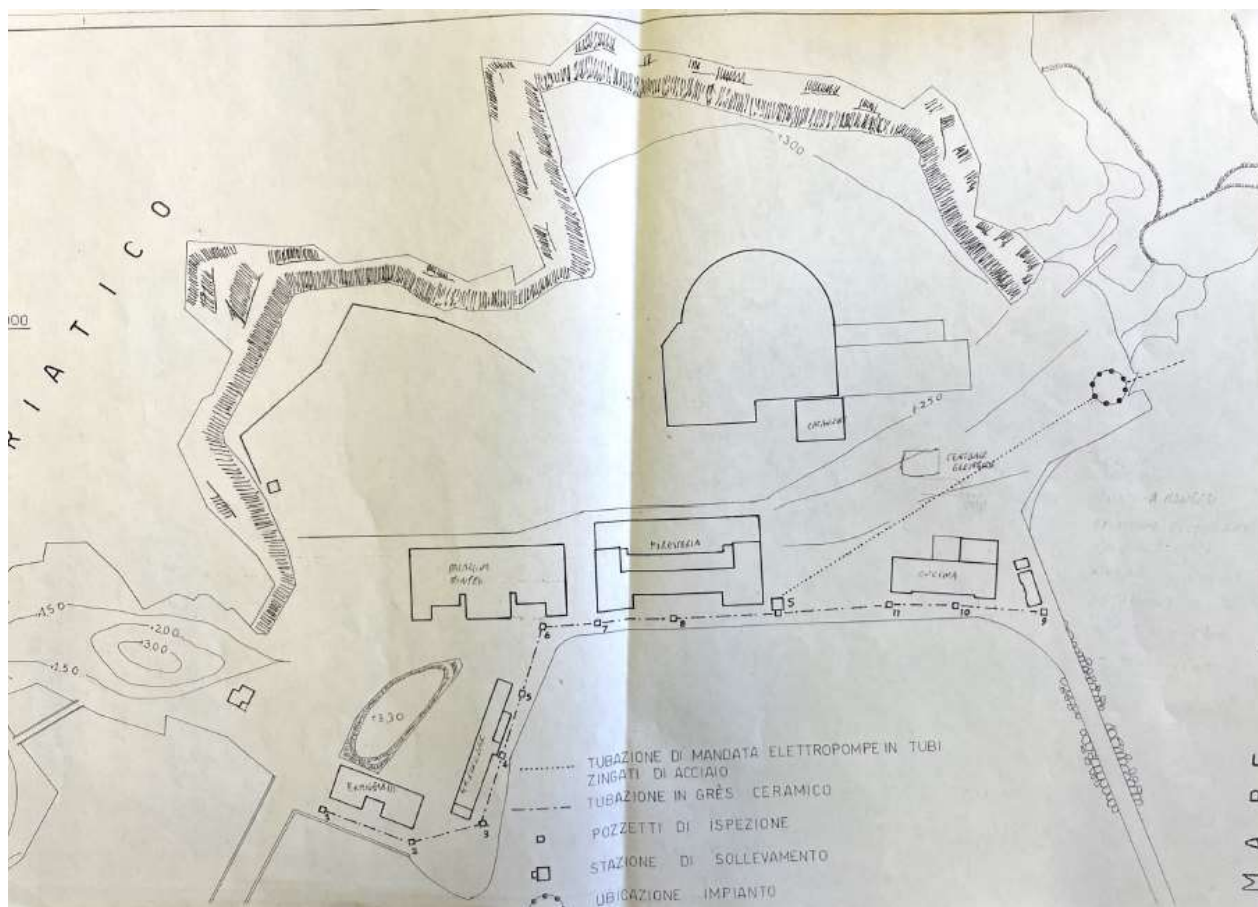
Stralcio planimetria generale distribuzione rete fognaria
